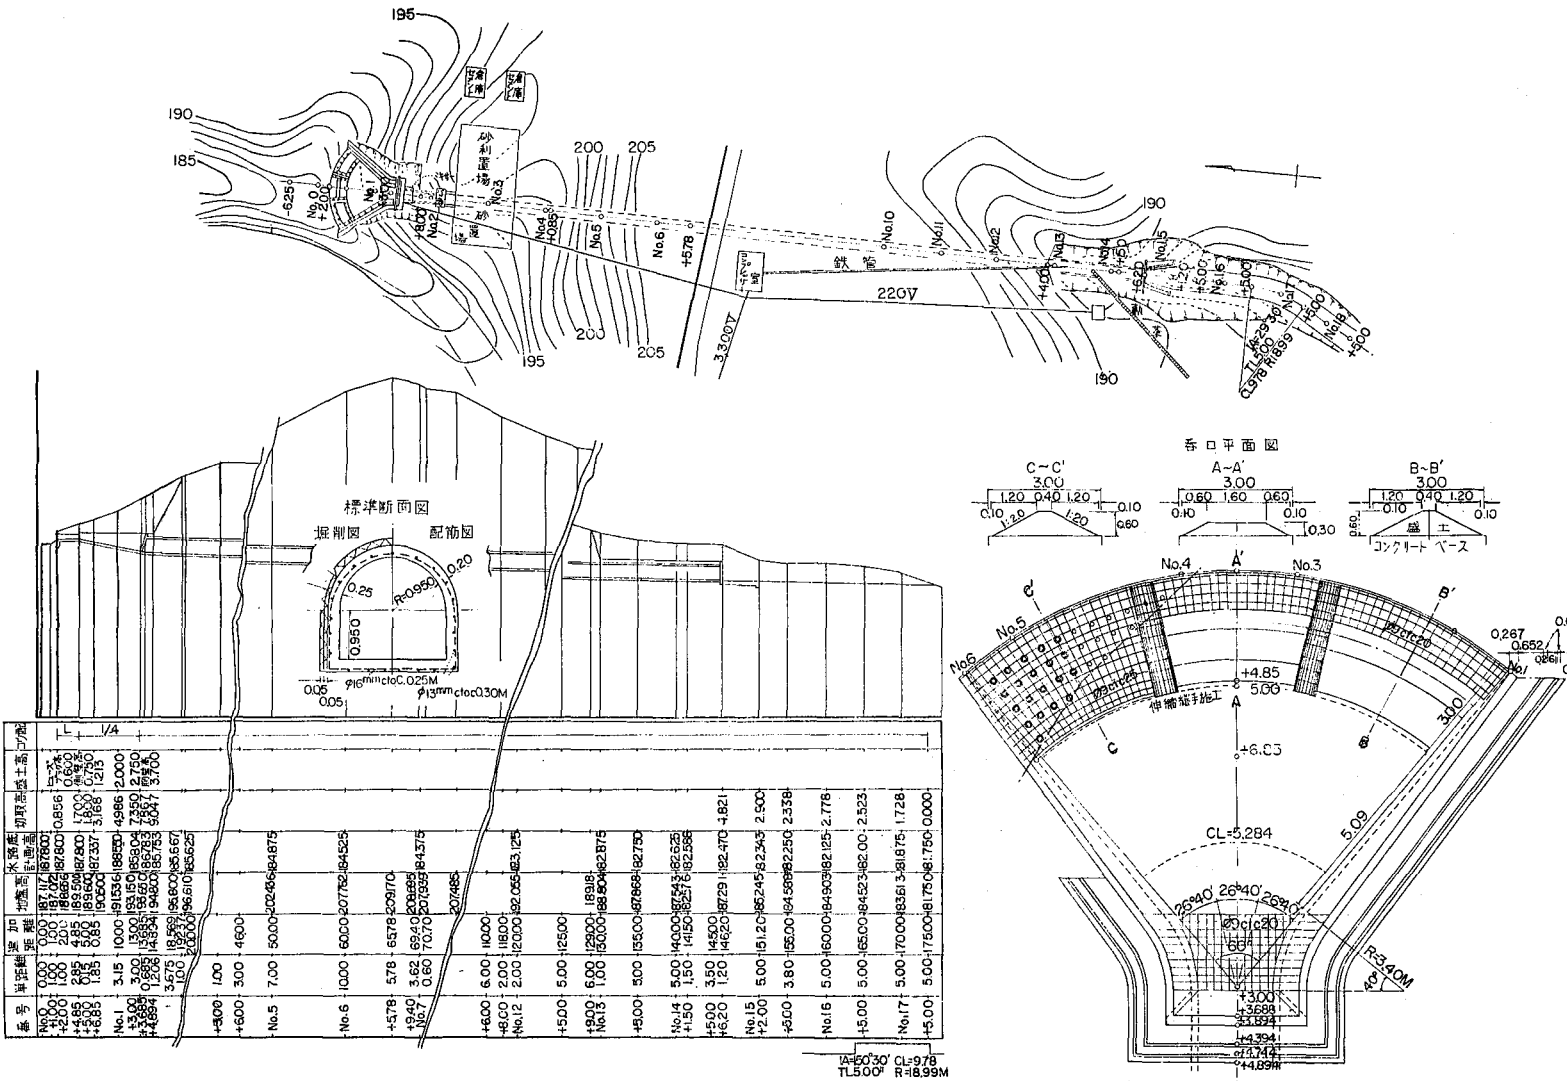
相野ダム非常余水吐構造図 Aino earth dam —Emergency spillway
